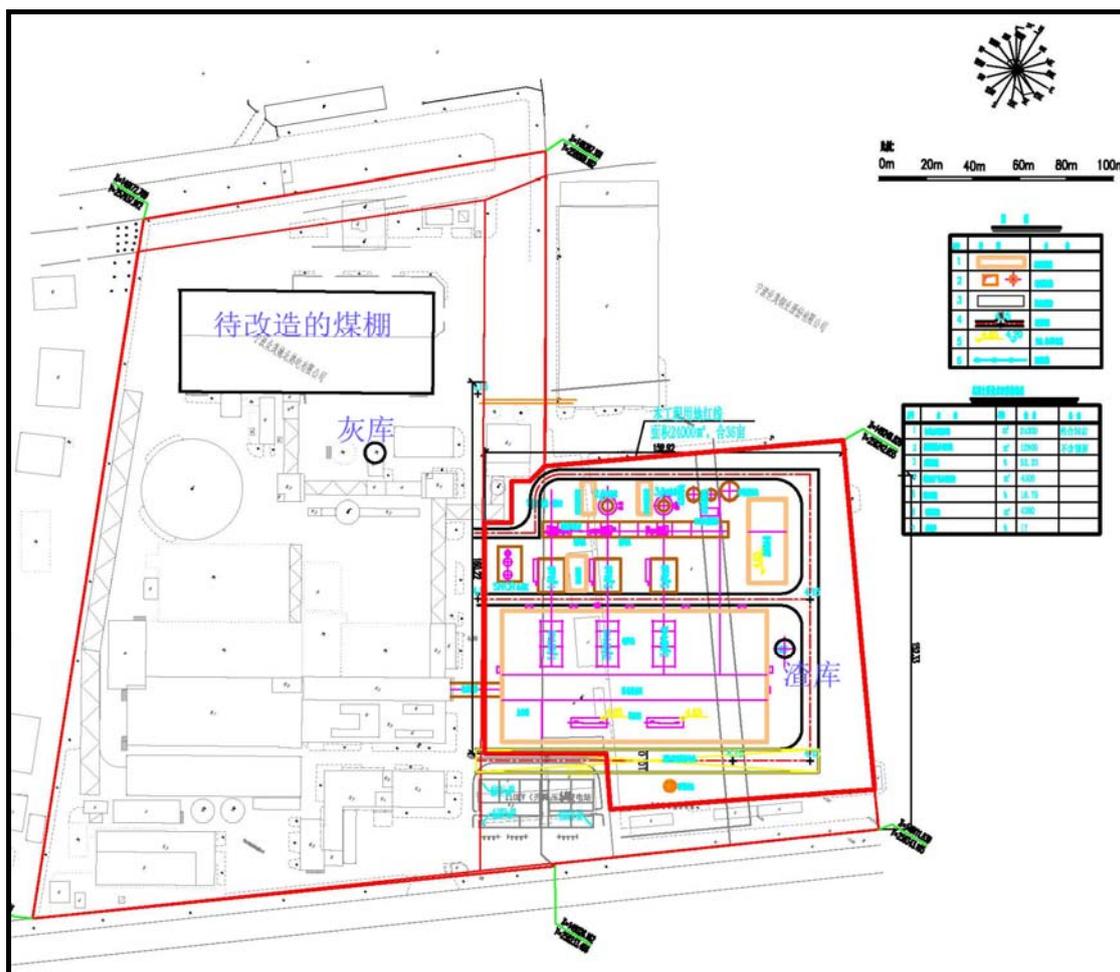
平面布置图及灰渣库、煤棚等的相对位置
